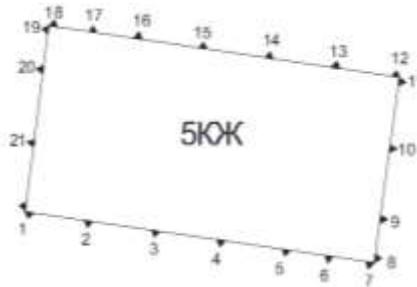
Схема размещения осадочных марок по контуру здания
